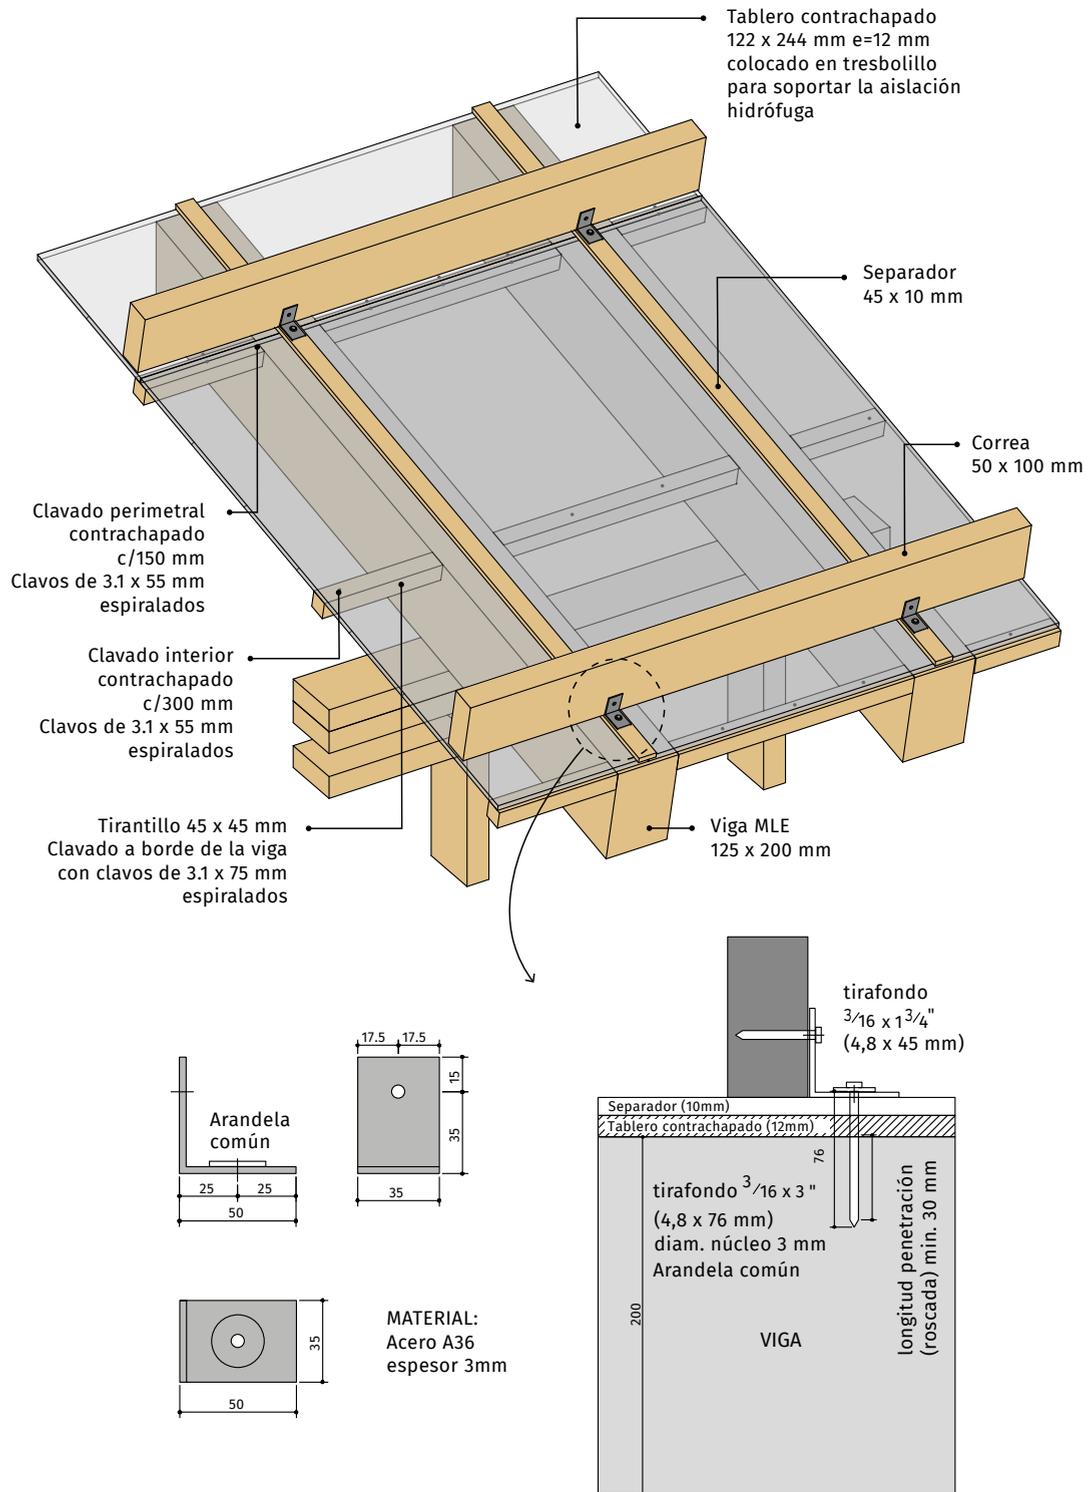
Detalle de la colocación de las correas y su unión a las vigas de cubierta
